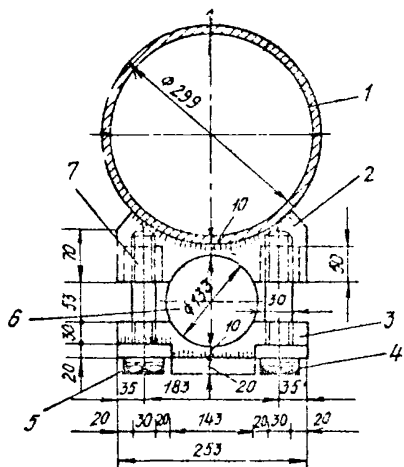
Конструктивный вариант жесткого крепления вибратора ИВ-60 (С-826) к бетонной трубе: а - при глубинах бетонирования до 20 м; 1 - бетонная труба; 2 - подкладка; 3 - накладка; 4 - натяжной болт; 5 - отверстие под шпильку; 6 - вибратор; 7 - вкладыш диаметром 50 мм, высотой 50 мм
